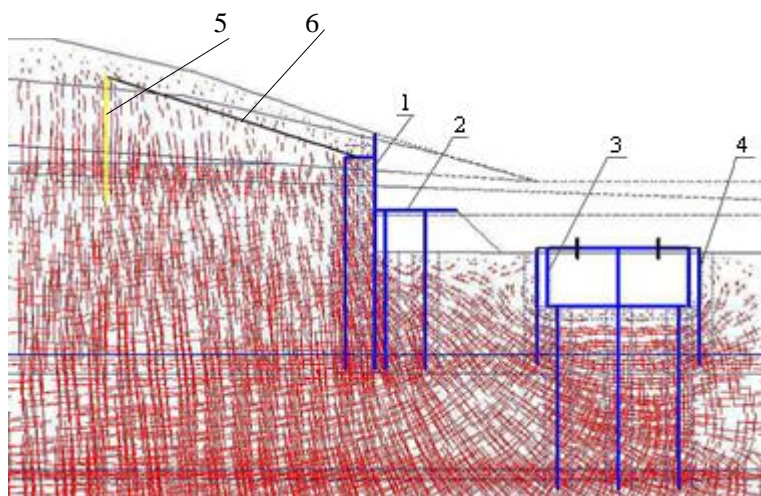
Схема обеспечения устойчивости Черепановой горы при разработке котлована и грунта под эстакадой:
